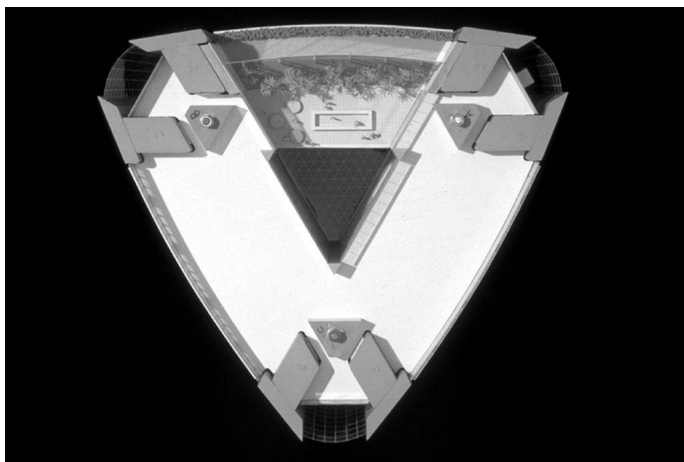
Planta del edificio del Commerzbank en Frankfurt.
